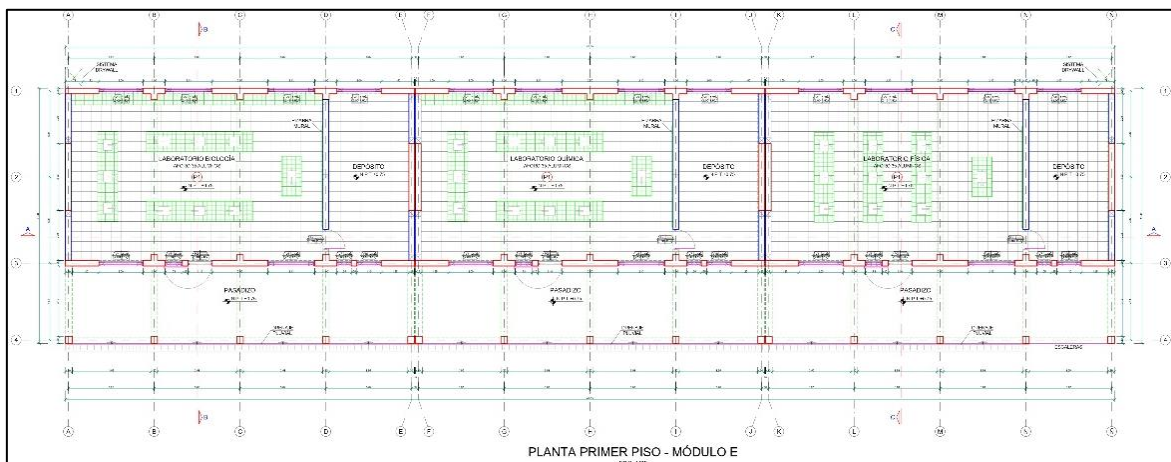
Distribución arquitectónica del módulo "E" – Planta Primer Piso
